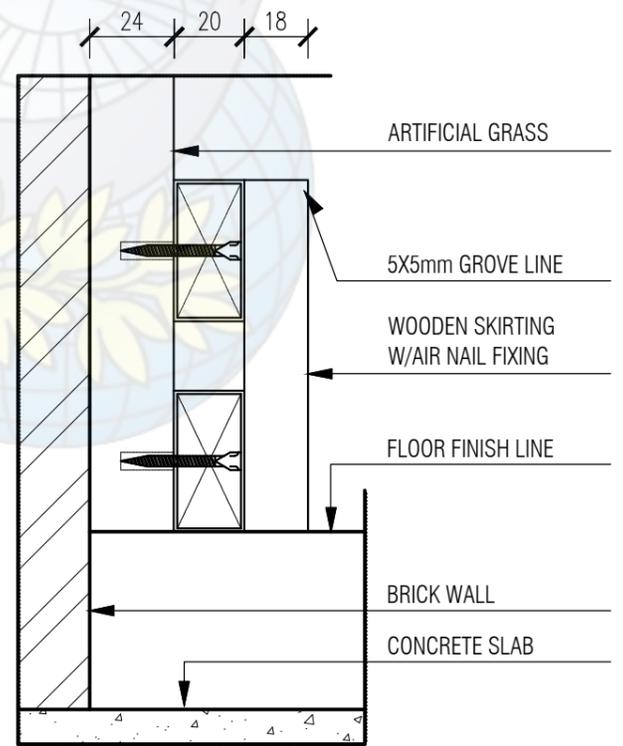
DETAIL SISTEM INSTALASI VERTICAL GARDEN
